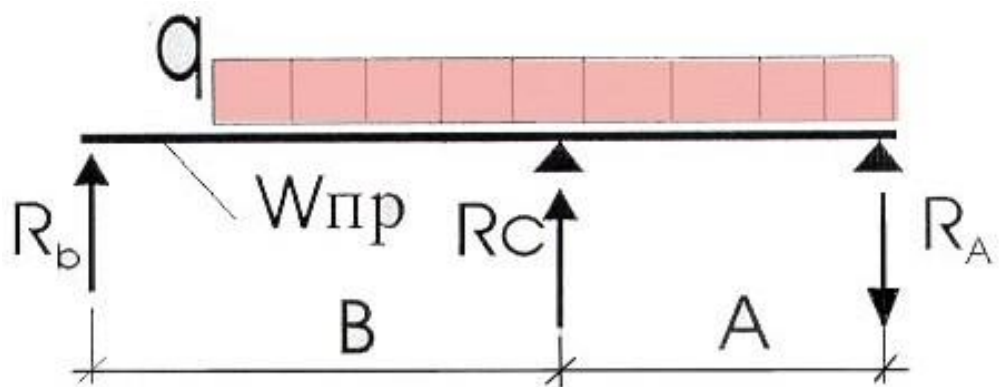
Расчетная схема усиление балки междуэтажного перекрытия боковыми накладками: R_b – опорная реакция балки; q – погонная нагрузка на балку; B , A – привязка нагельных групп и центра опорной площадки балки; $W_{пр}$ – момент сопротивления протеза (бок. накладок); R_c , R_a – усилия в нагельных группах
